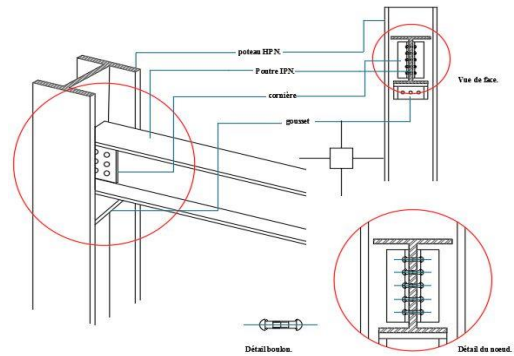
Assemblage boulonné d'une poutre à l'âme d'un poteau
